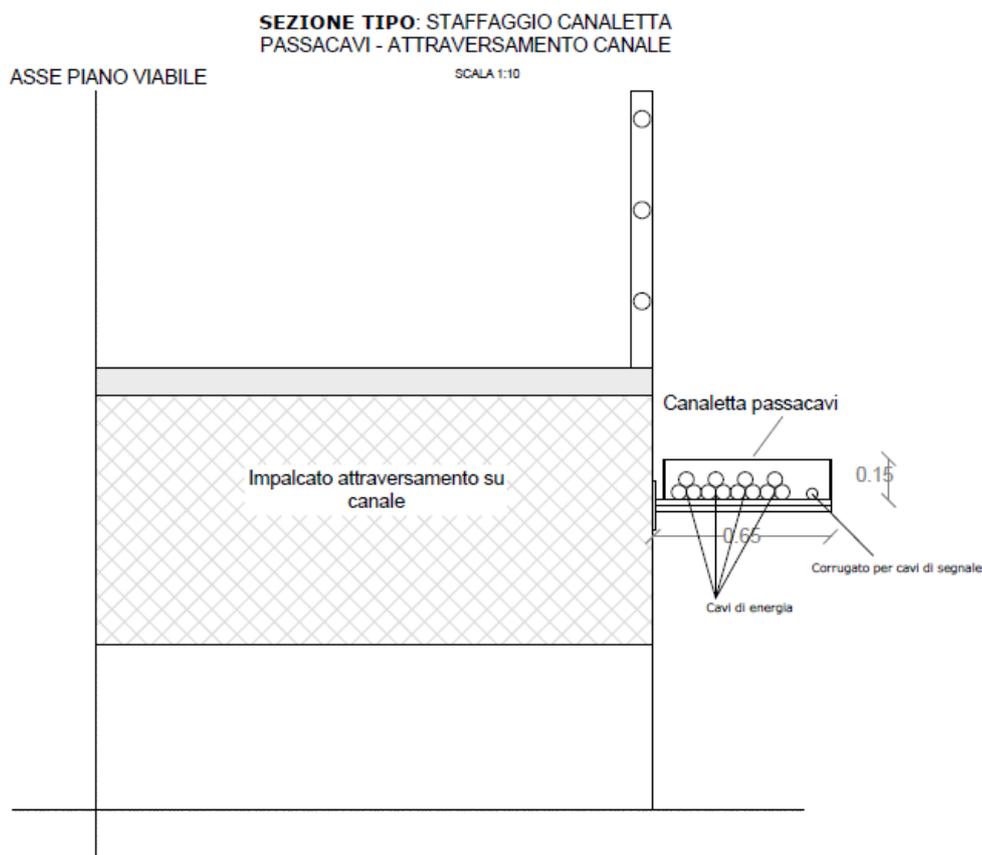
Sezione tipo posa in canaletta in fiancheggiamento al ponte esistente
